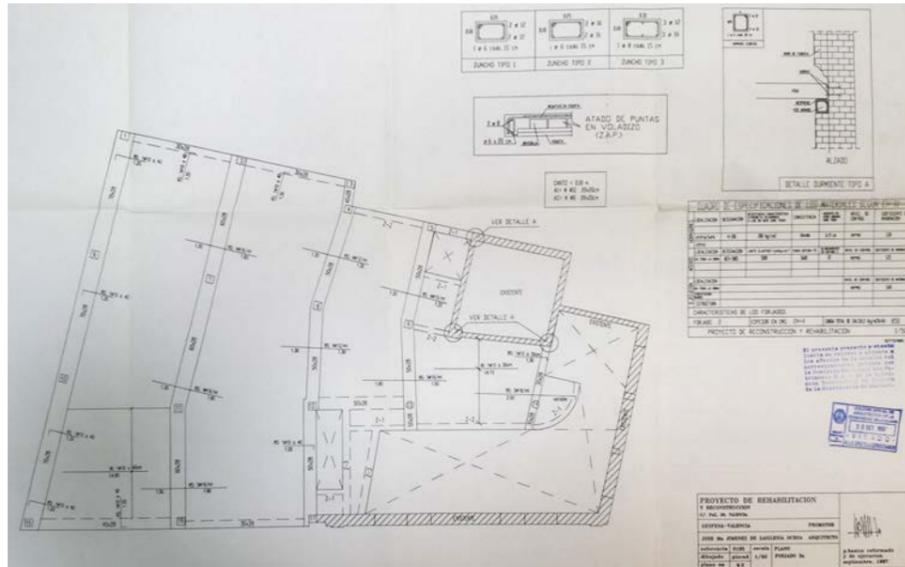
Proyecto inicial intervención. Plano estructura forjado 2.
